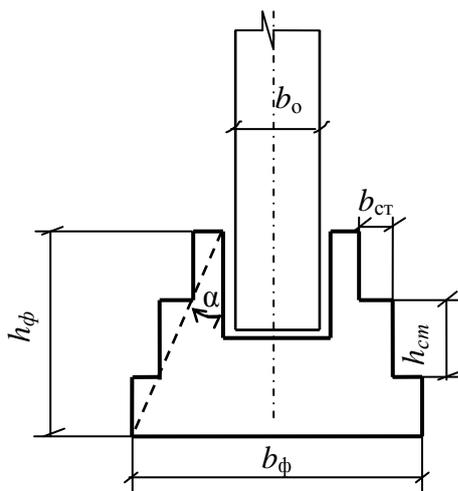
Конструкция фундамента мелкого заложения
